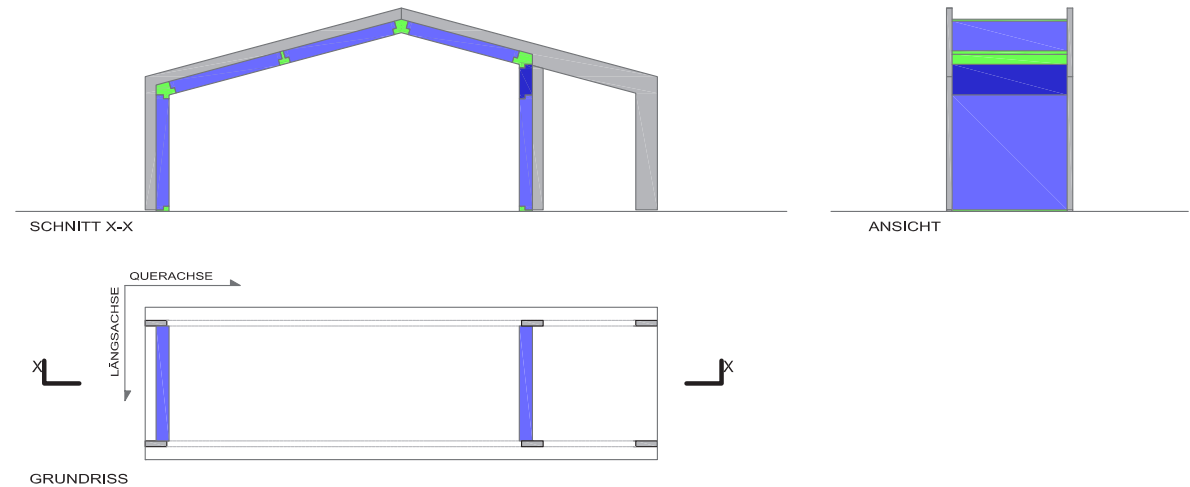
| Systemgrundriss mit Wandversatz, Schnitt und Ansicht
